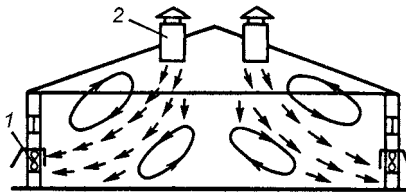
Витяжна вентиляція з настінними вентиляторами: 1 – настінні вентилятори; 2 – припливні шахти
